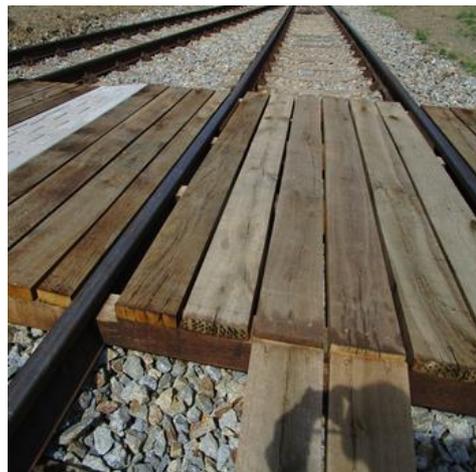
Zakrytí úchytů a prostupů betonových panelů (například, provizorní zastávky ND/NAD)
